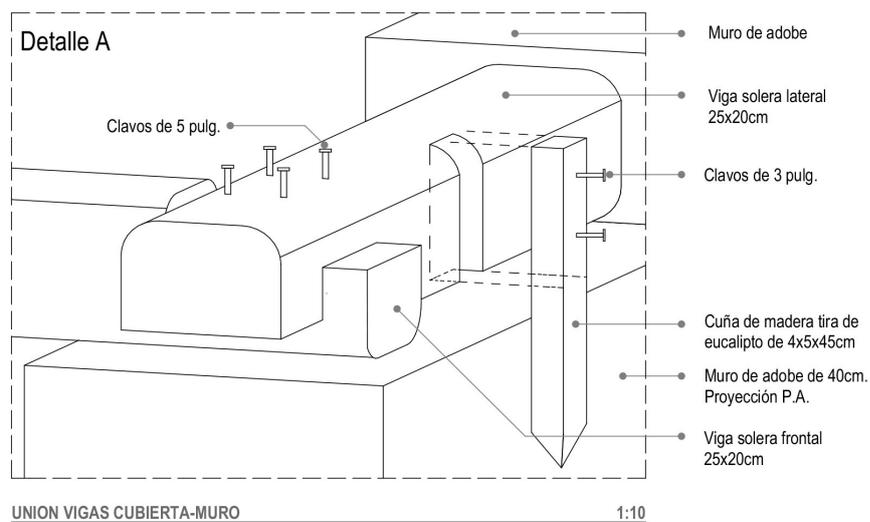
Axonometría de la unión viga de cubierta-muro C 101
